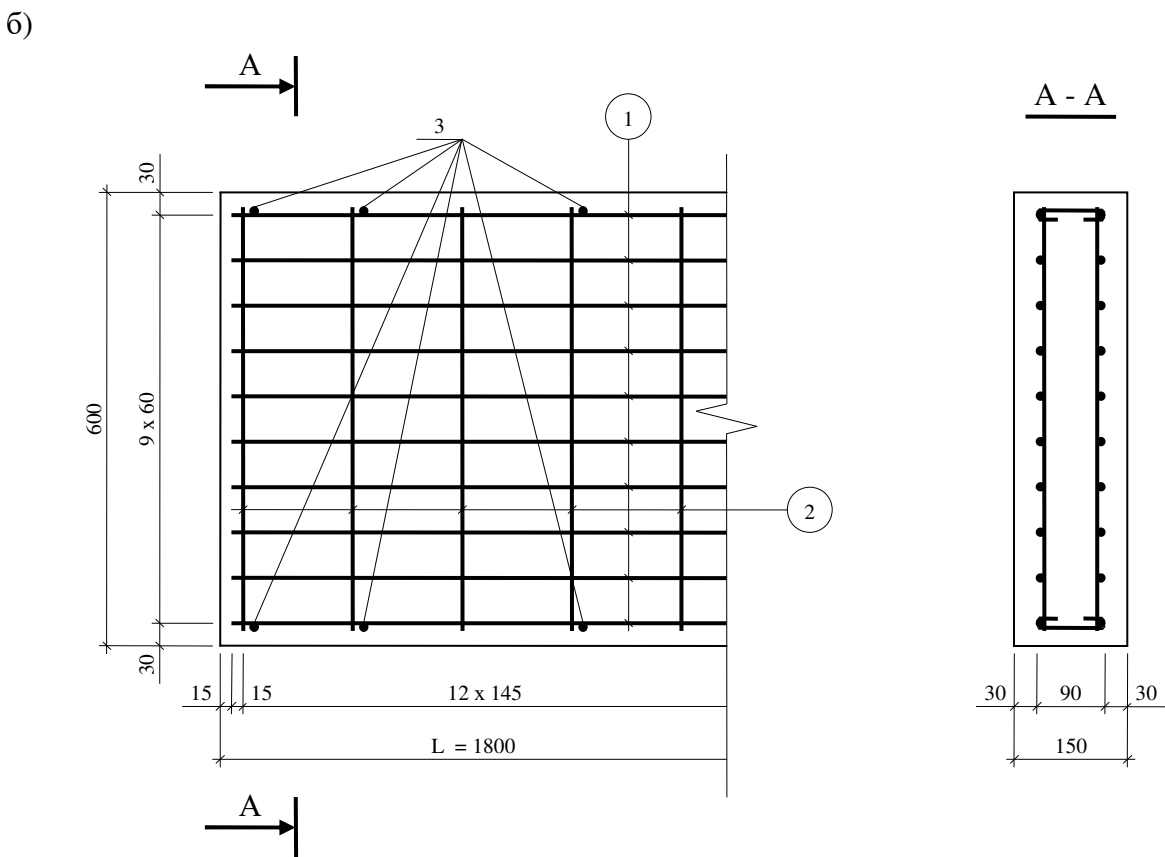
Схема армирования ступеней: а) - простые ступени ЛС; б) - плиты ЛСП
